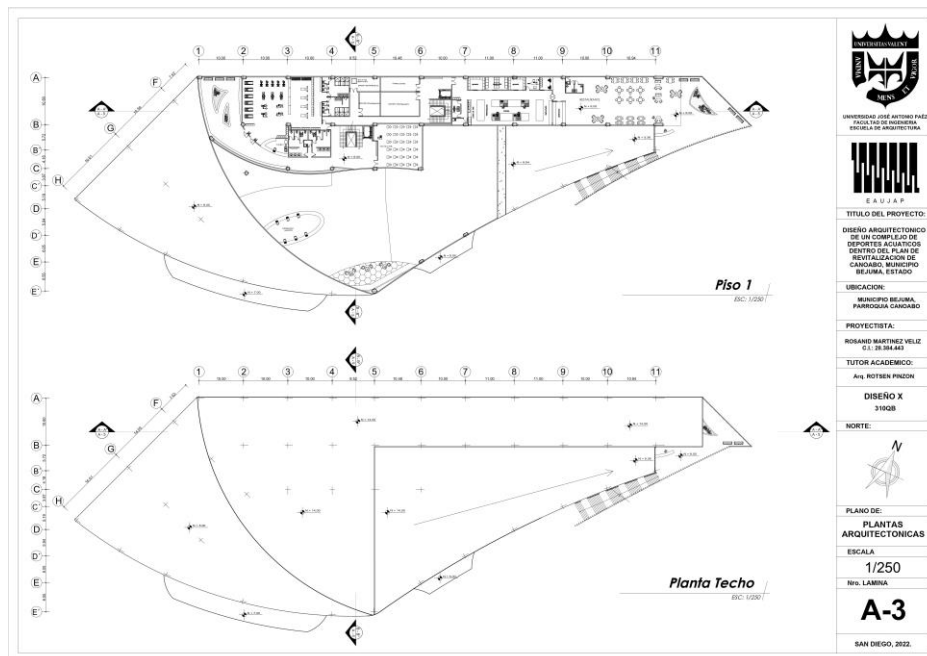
Planta Nivel 1 +6.00 y Planta Techo +12.00. Fuente: La autora (2022).
